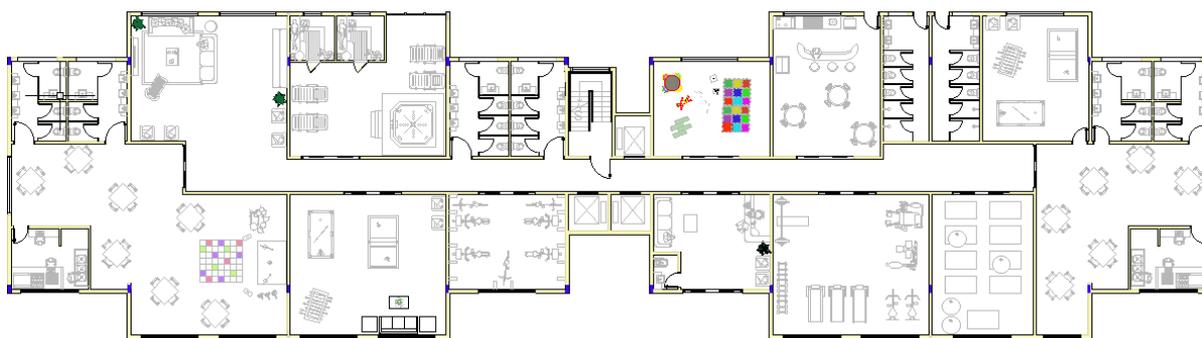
Pavimento Térreo Residencial (Produção da autora)
